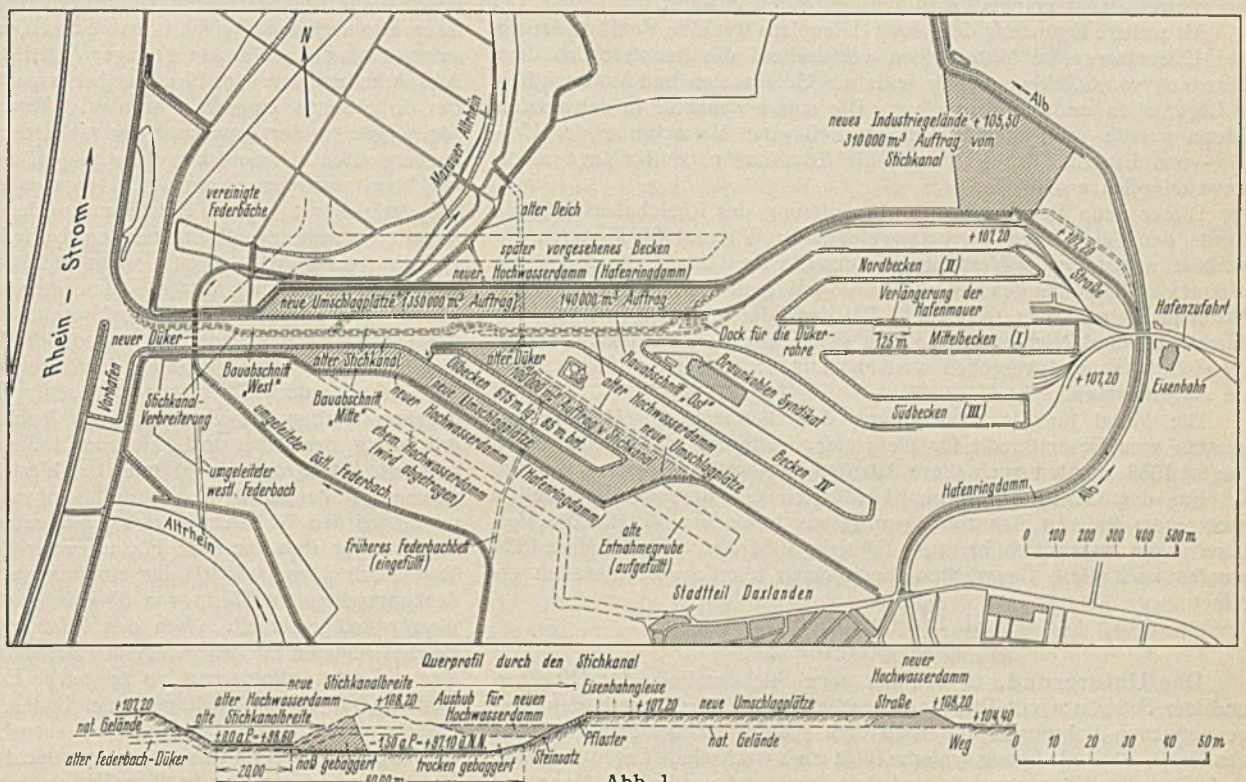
Lageplan der Baustelle und Querprofil durch den Stichkanal.
